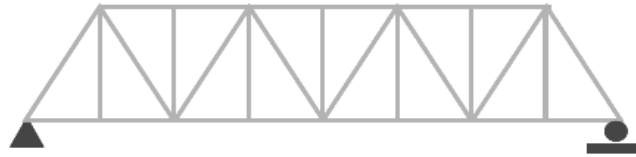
Jembatan Rangka Tipe *Petit Truss/Pennsylvania Truss
